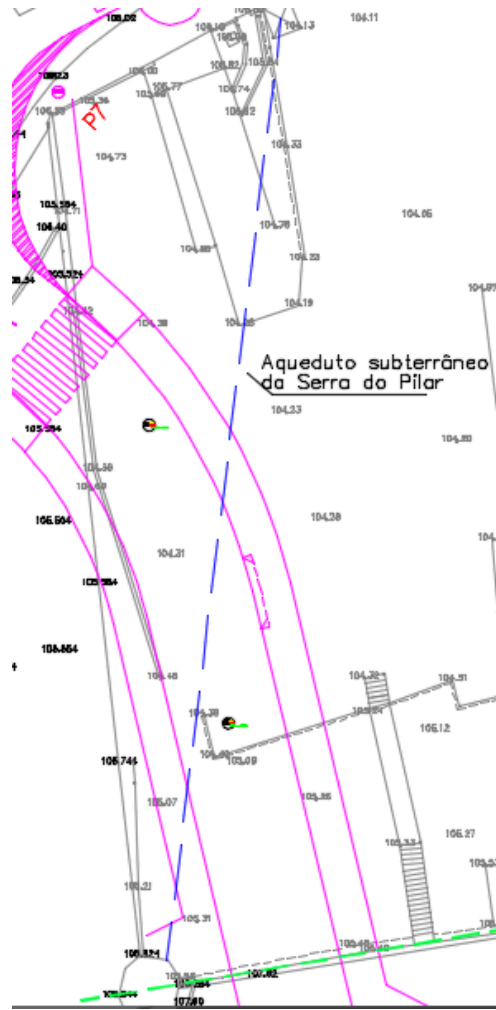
Planta de localização do aqueduto subterrâneo, indicado a azul tracejado (planta topográfica).
